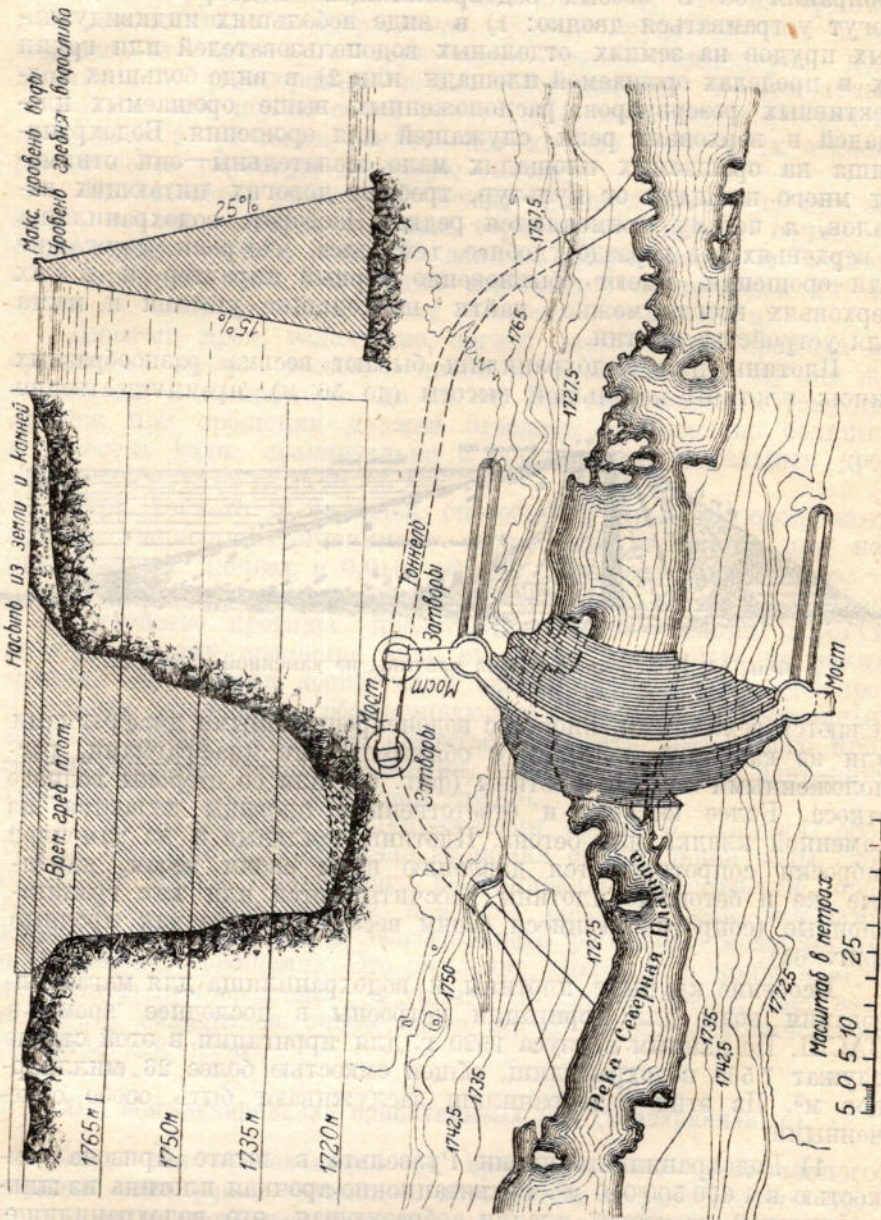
Поперечный разрез плотины из каменной наброски.
